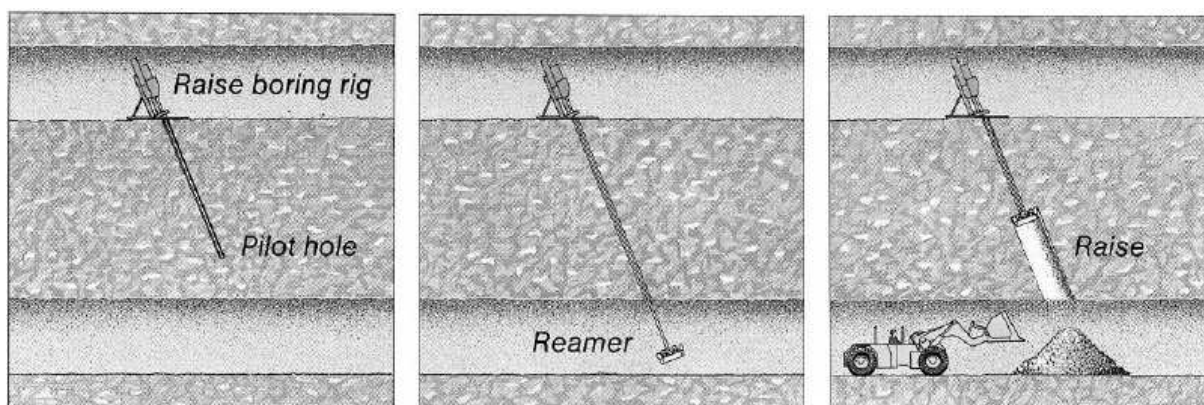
Esquema de escavação com recurso ao raise boring [6]
